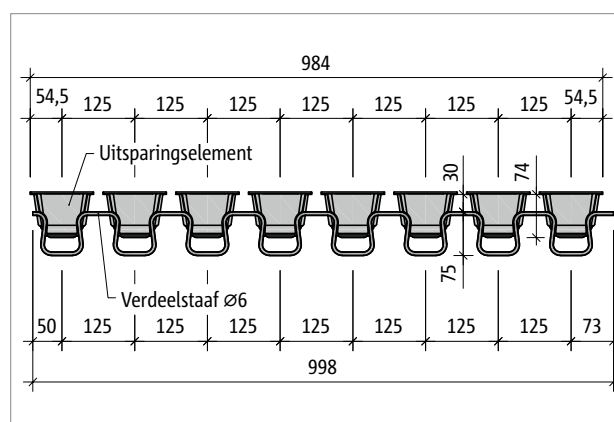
Schöck IDock1: Sectie A-A, doorsnede vloerelement
